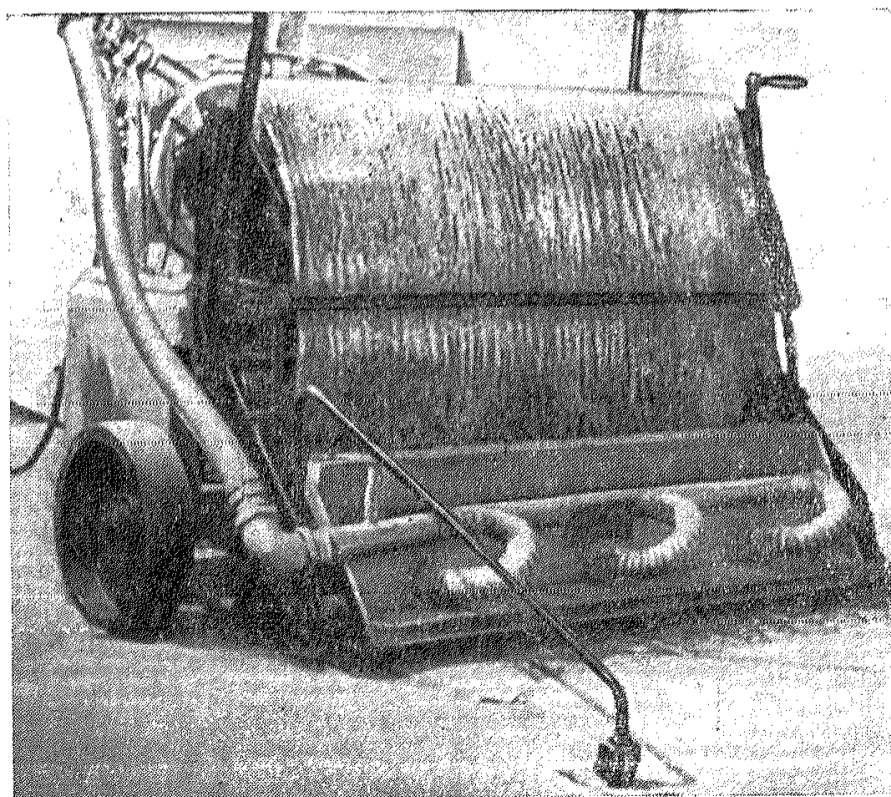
Общий вид машины СО-121 для устройства кровель с применением наплавляемого рубероида
